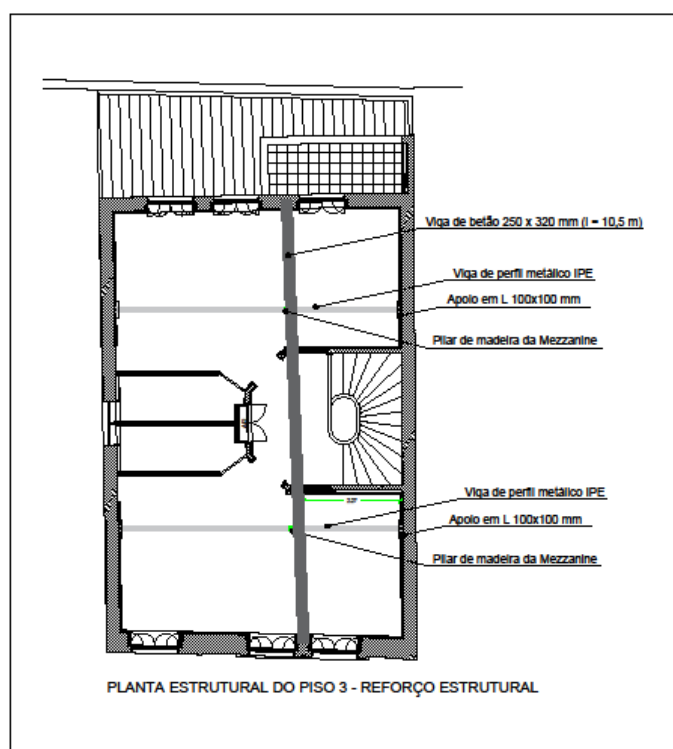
Planta estrutural do Piso 3 - Reforço estrutural
